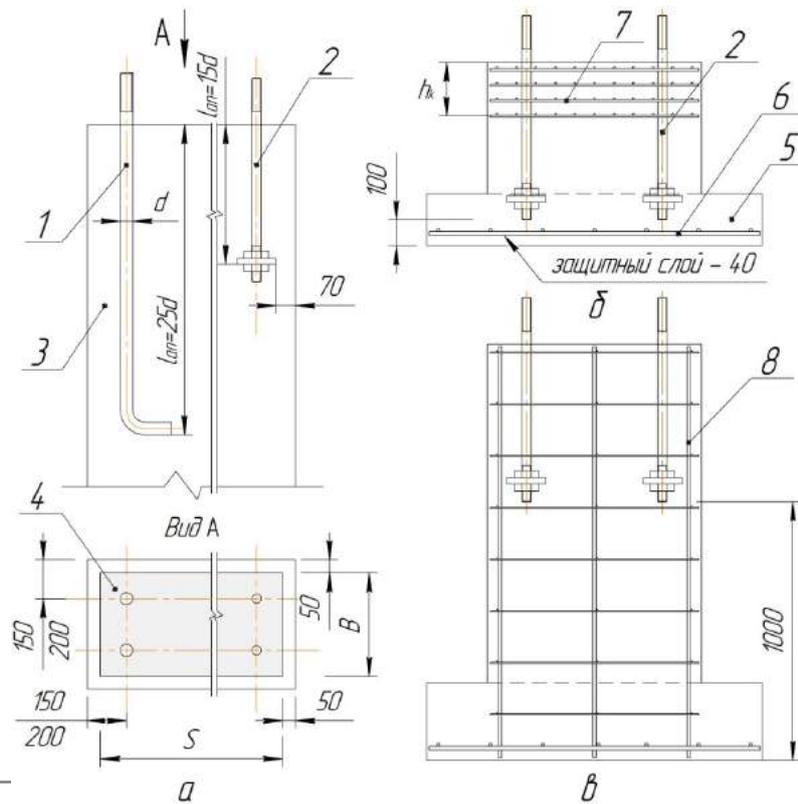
Примеры размещения фундаментных болтов (а), сеток косвенного армирования (б) и рабочей арматуры (в) в отдельном ступенчатом фундаменте: 1 – фундаментный болт с отгибом, 2 – фундаментный болт с анкерной плитой, 3 – подколонник, 4 – площадь приложения сжимающей силы на фундамент, 5 – плитная часть, 6 – сетка армирования плитной части фундамента, 7 – сетки косвенного армирования, 8 – рабочая арматура подколонника
